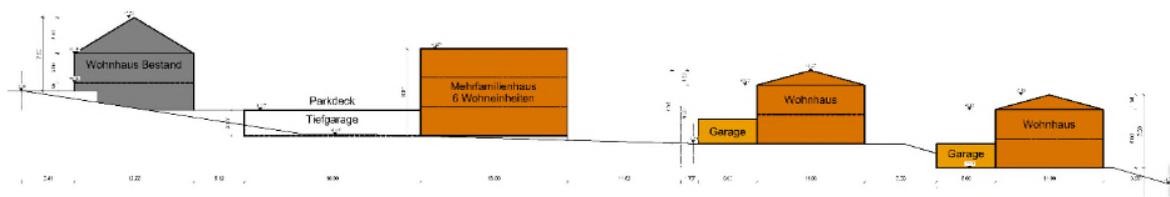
Geplante Bebauung (orange) und Bestand (grau) im Schnitt
